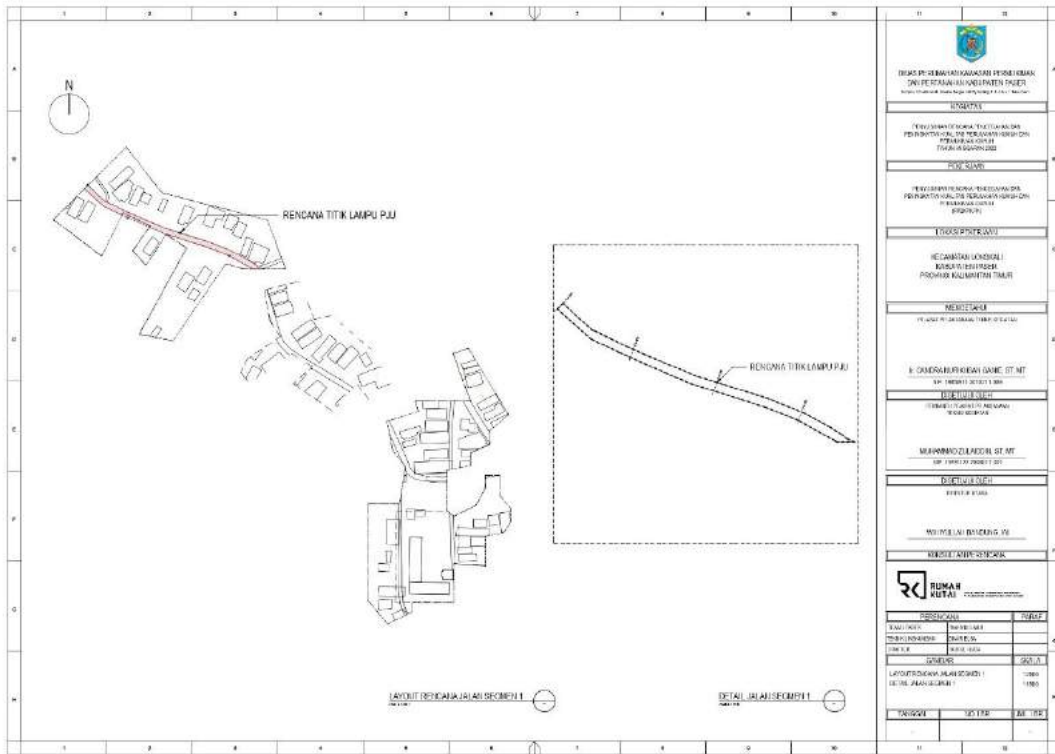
61 Konsep Detail Rencana Jalan RT.11
